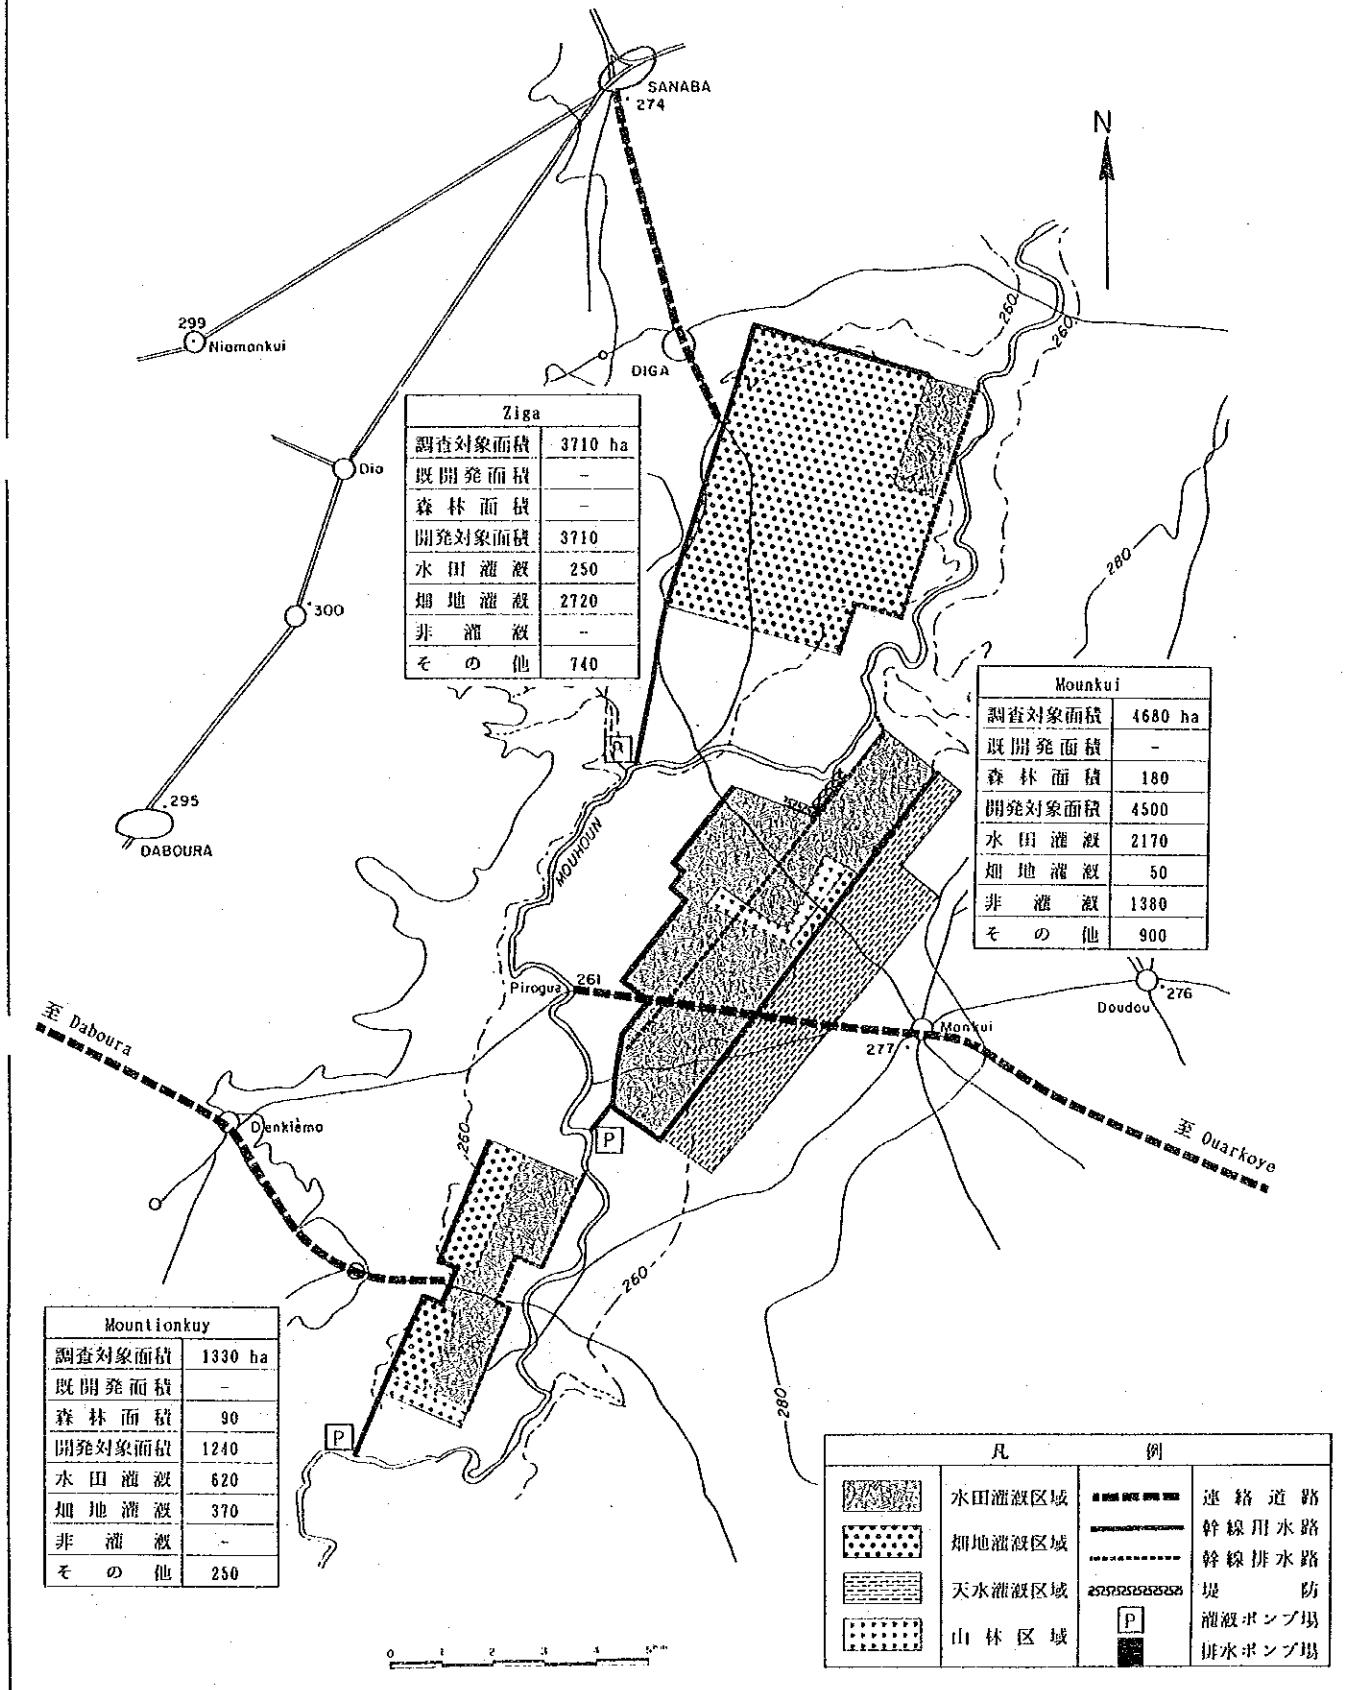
(2) 計画平面図 (ムウン川流域その2)
